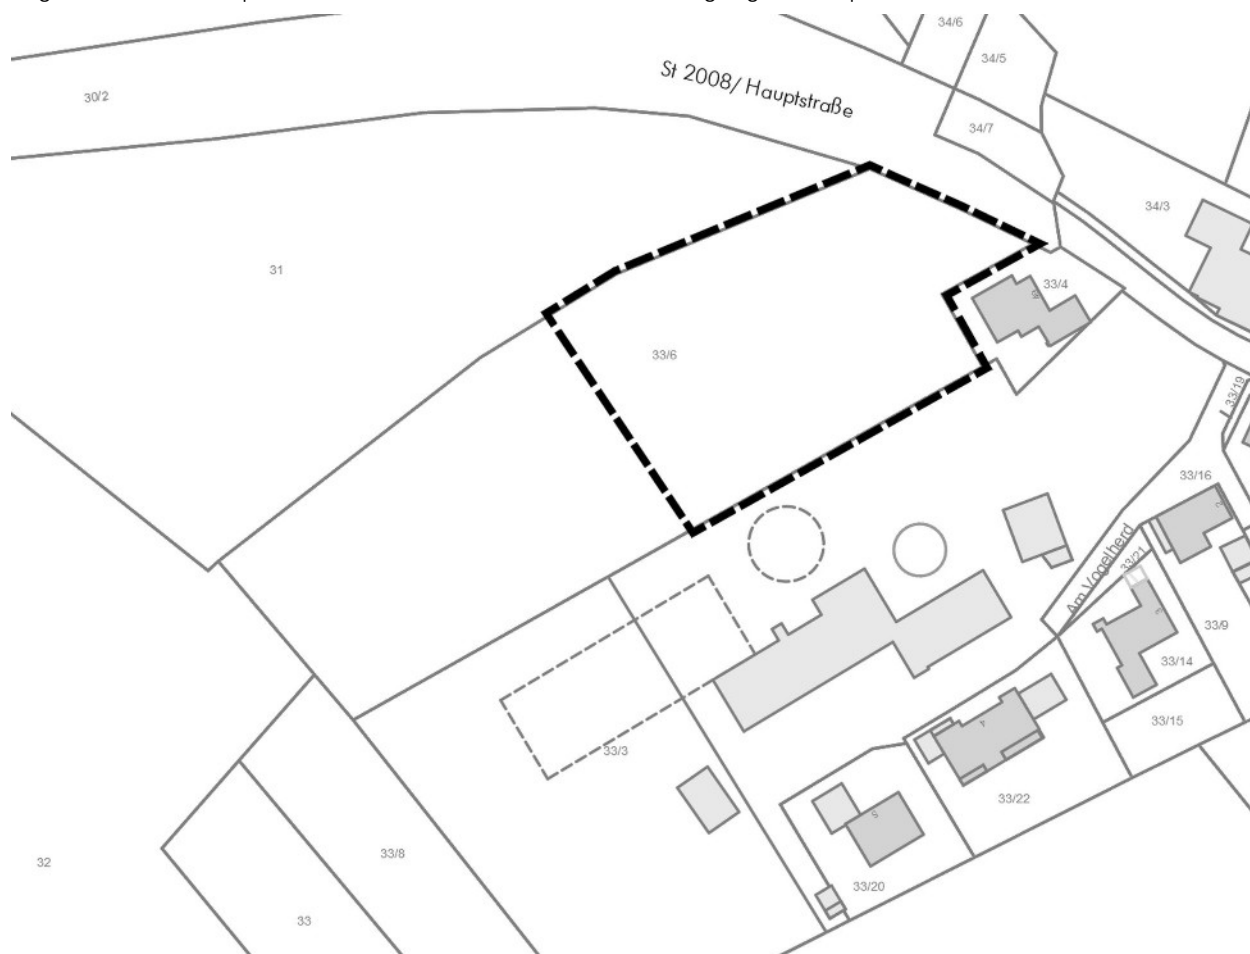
Lageplan des Geltungsbereiches, unmaßstäblich
